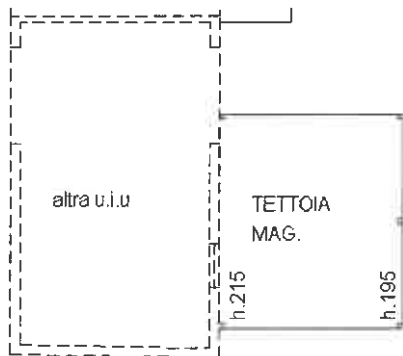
Estratto planimetria catastale relativa alla tettoia
